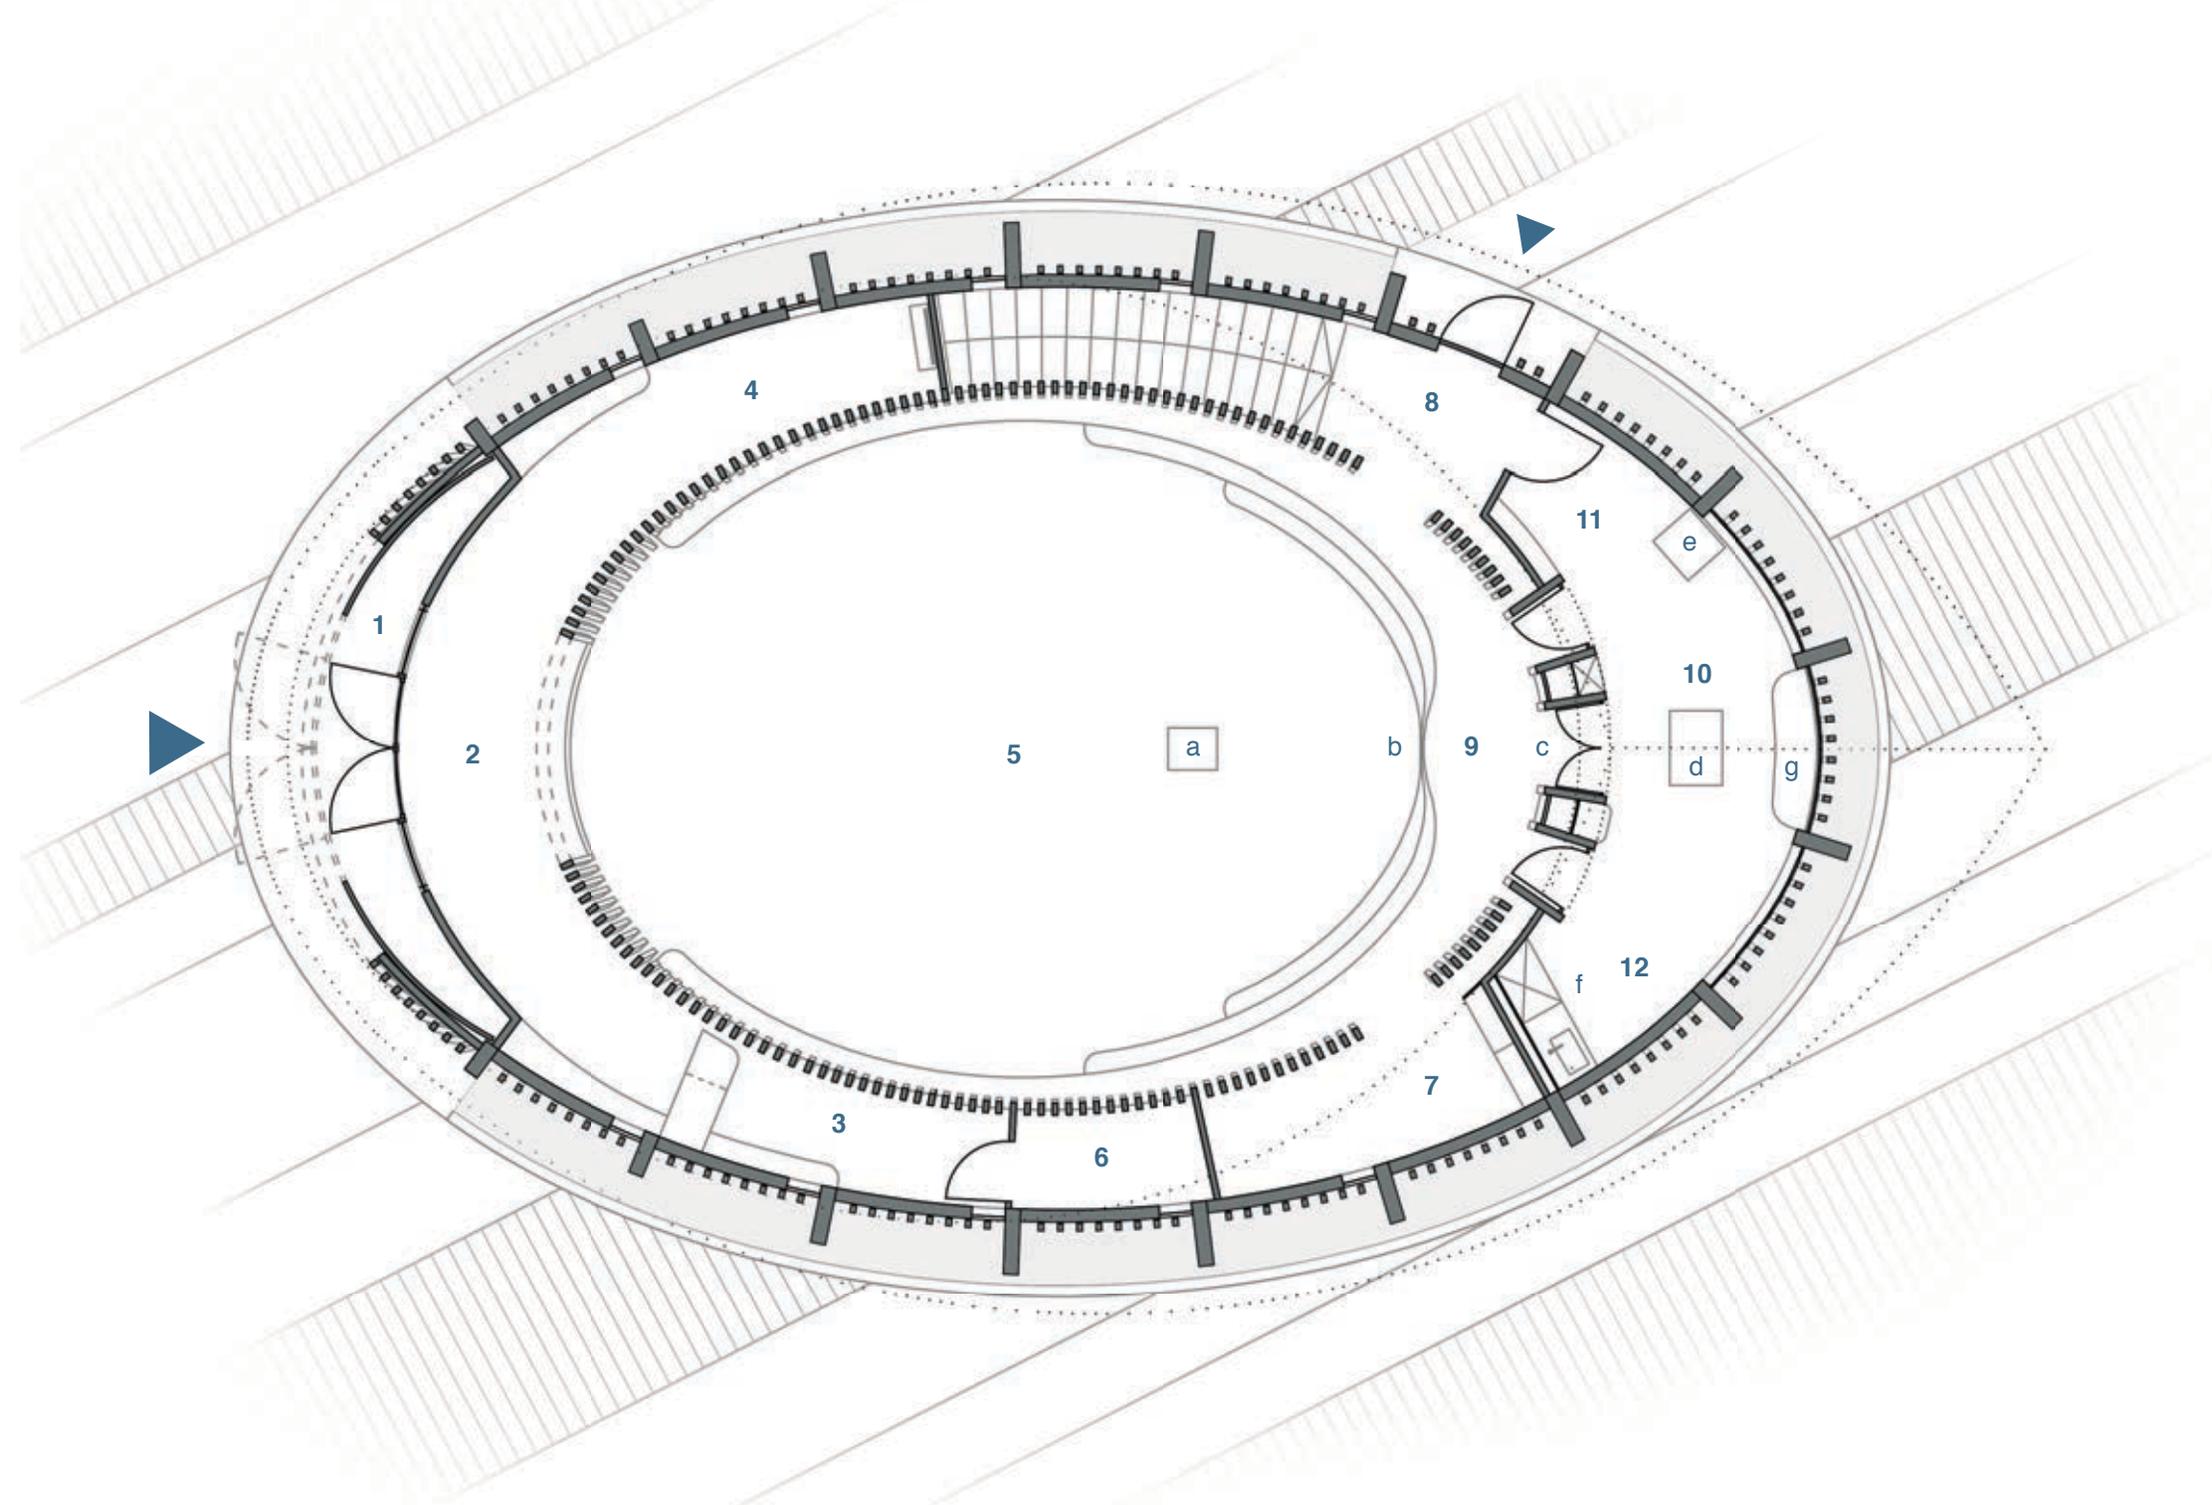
Plan: Grundriss - Erdgeschoss
